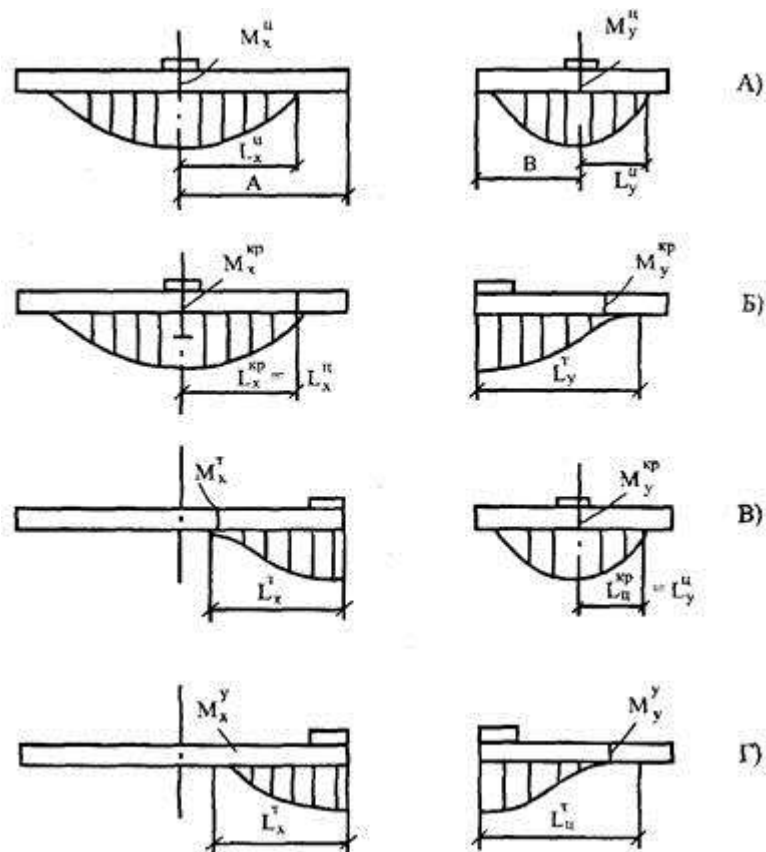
Расчетные места приложения нагрузки и расчета точки определения изгибающих моментов в плитах сборных покрытий
